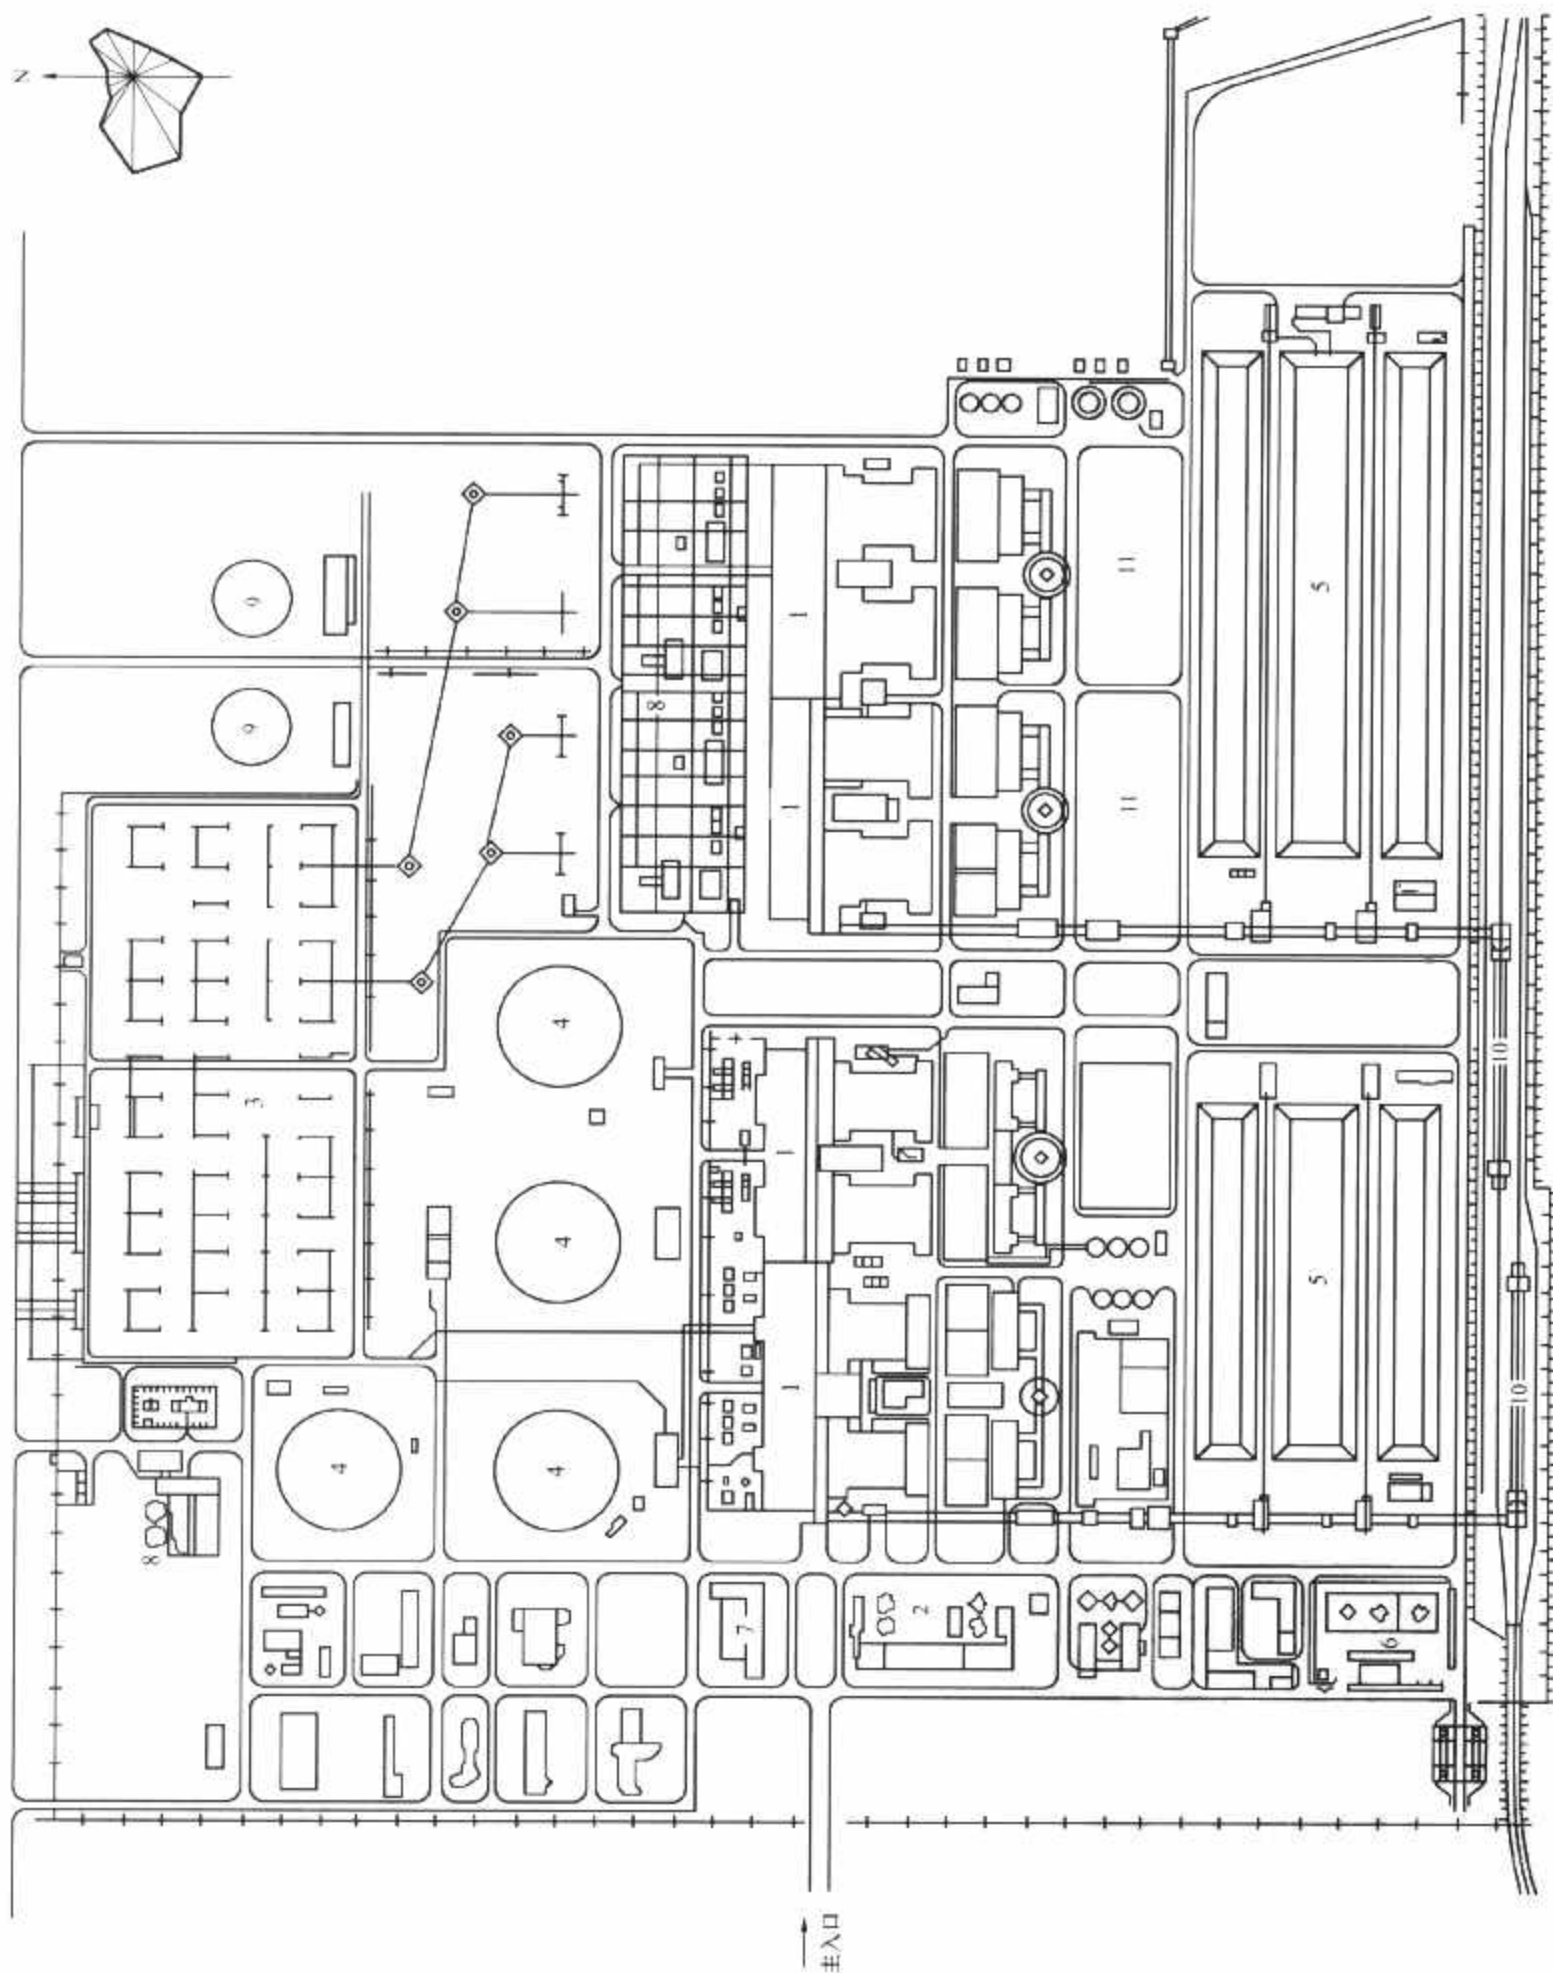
兼有湿冷和直接空冷机组的四列式电厂总平面布置图
